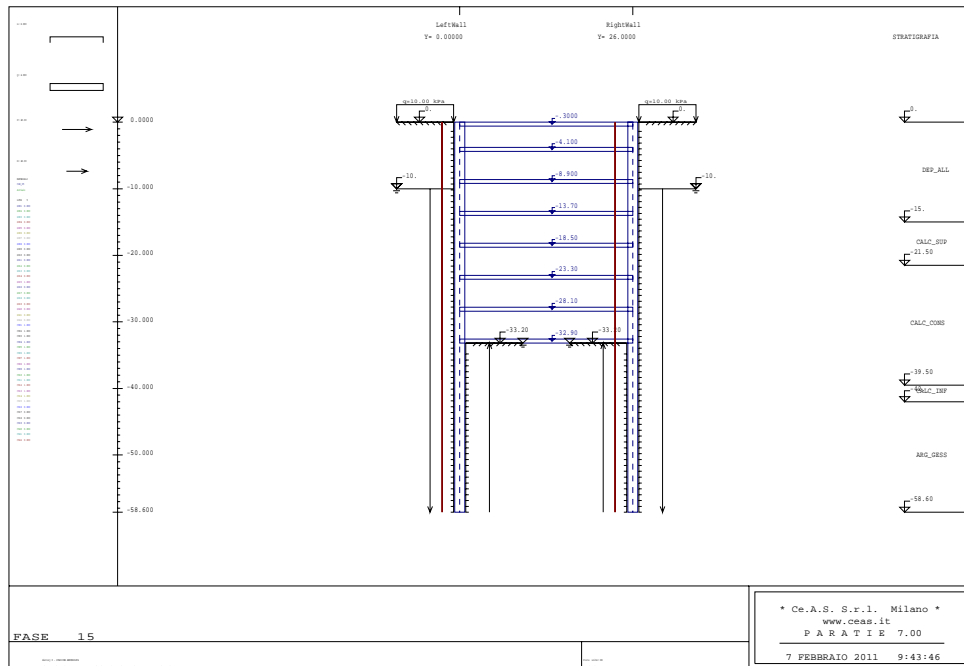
Fase 15: Getto solaio a +34.71m s.l.m.
